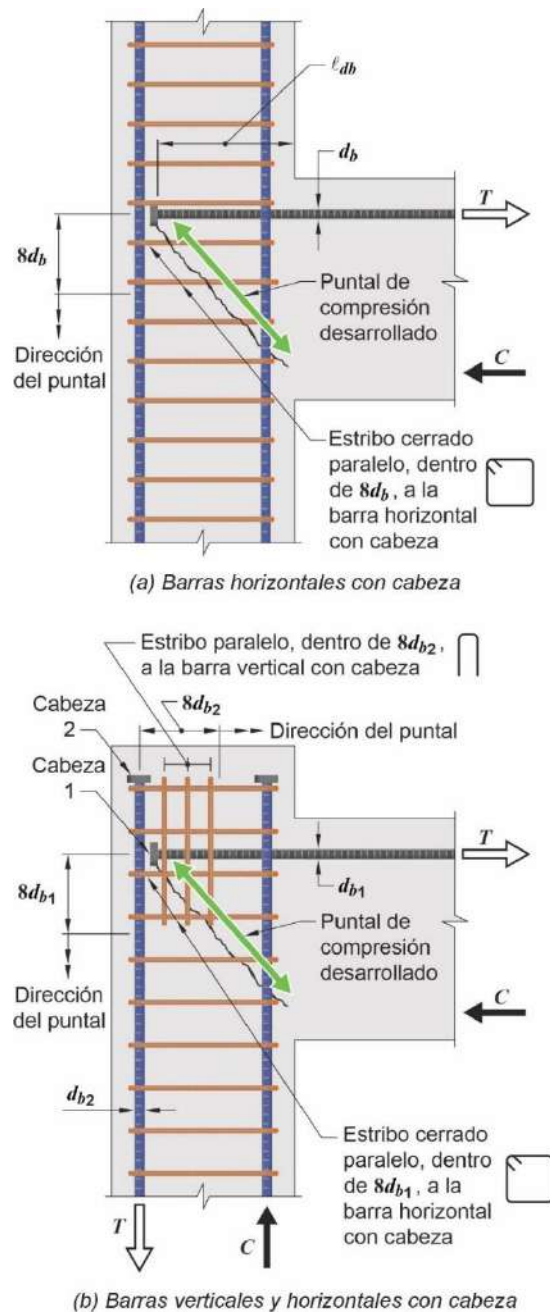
Estribos abiertos o cerrados colocados paralelos a las barras con cabeza de la viga que
